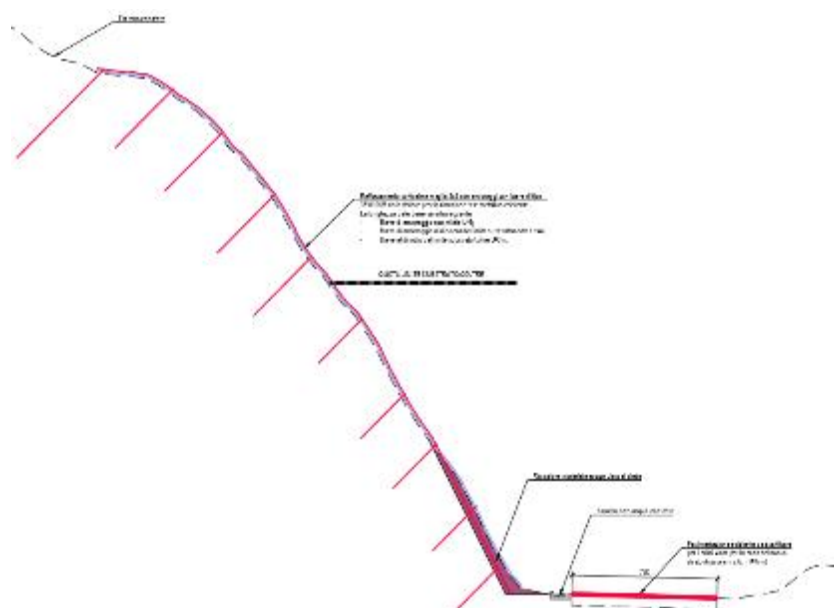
Sezione tipo 2- Rafforzamento corticale a maglia 3.00x3.00m
